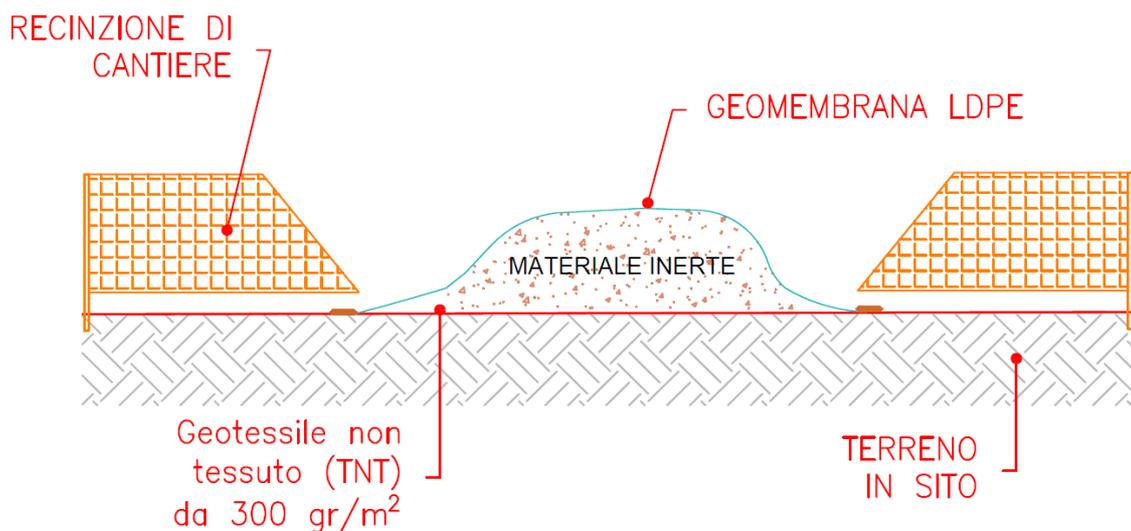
Allestimento area deposito materiali inerti su area non pavimentata
